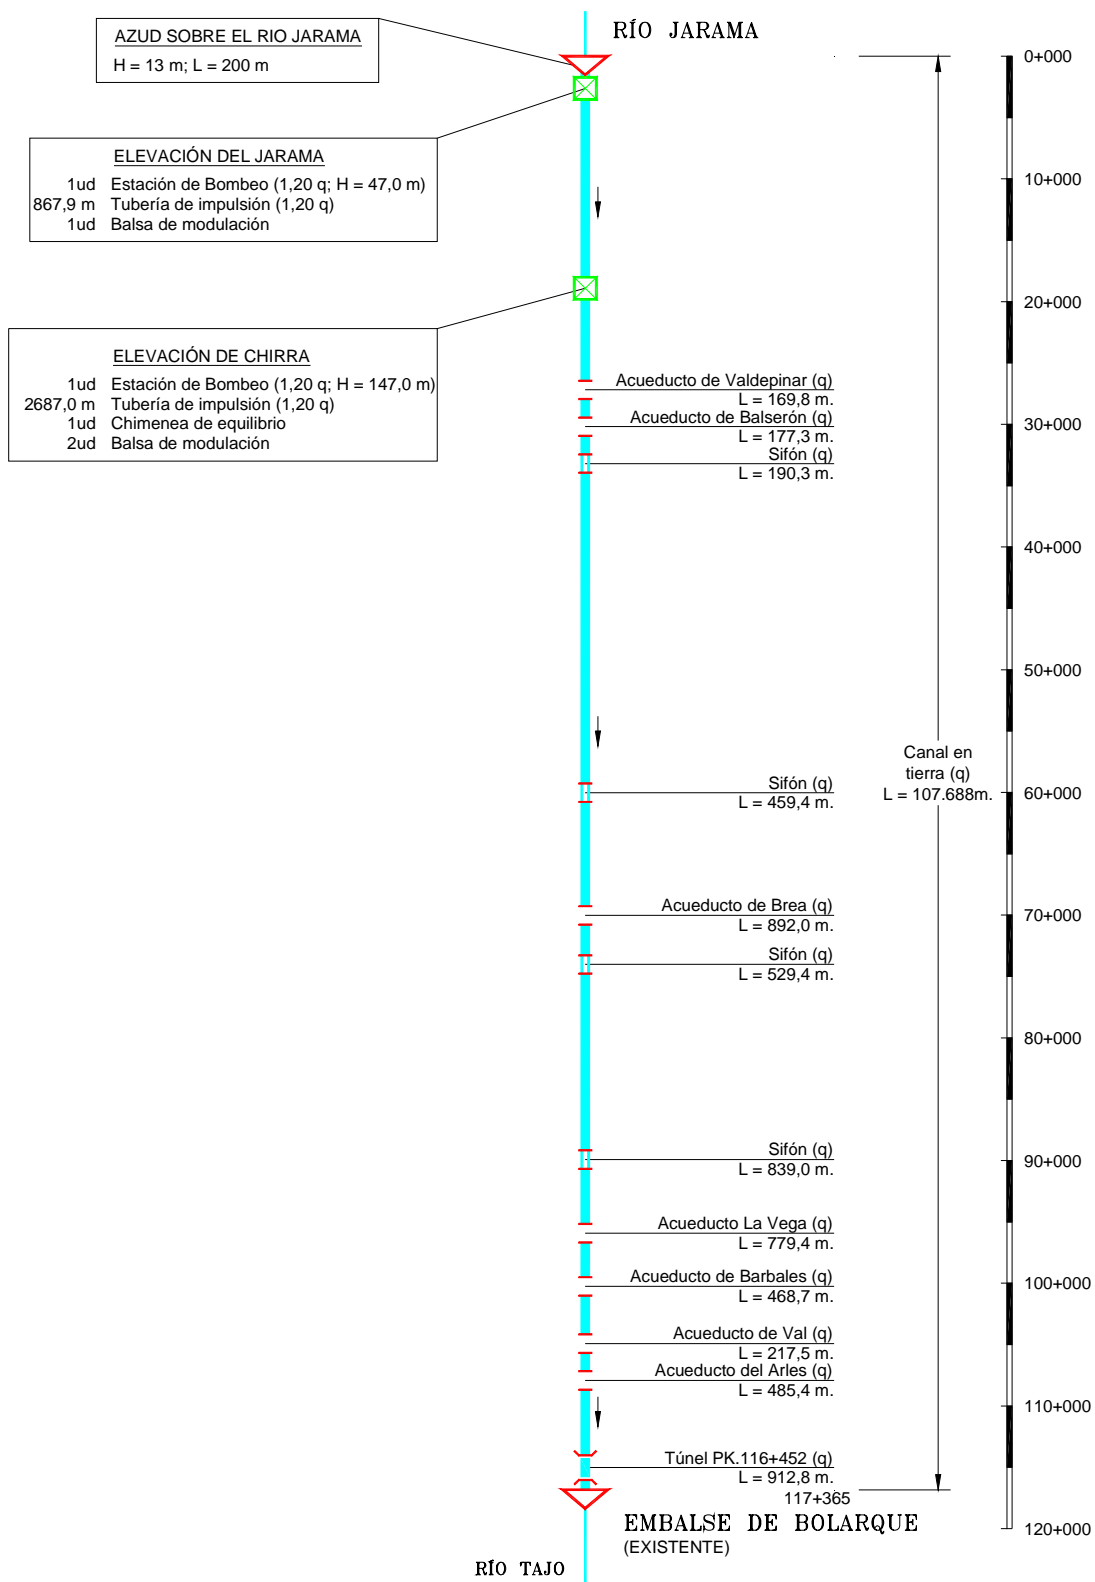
Conducción Jarama - Bolarque. Esquema en planta
